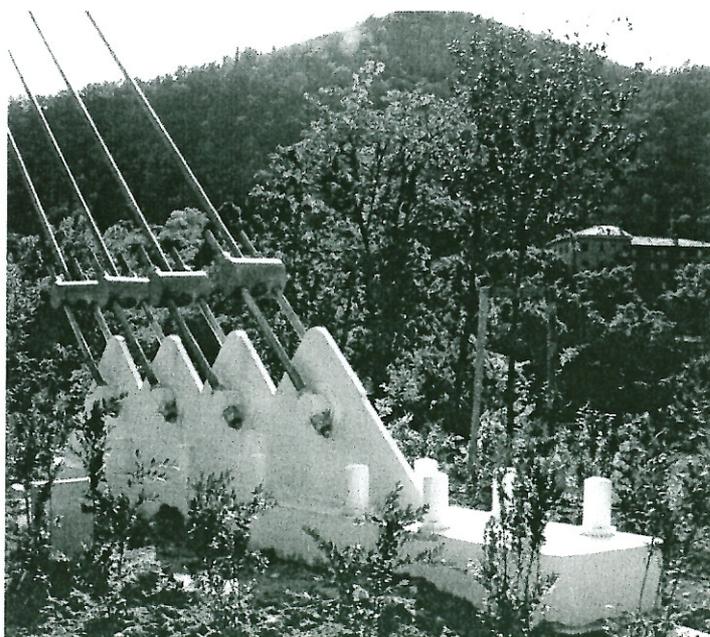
Il cavalletto d'ancoraggio: particolare C
